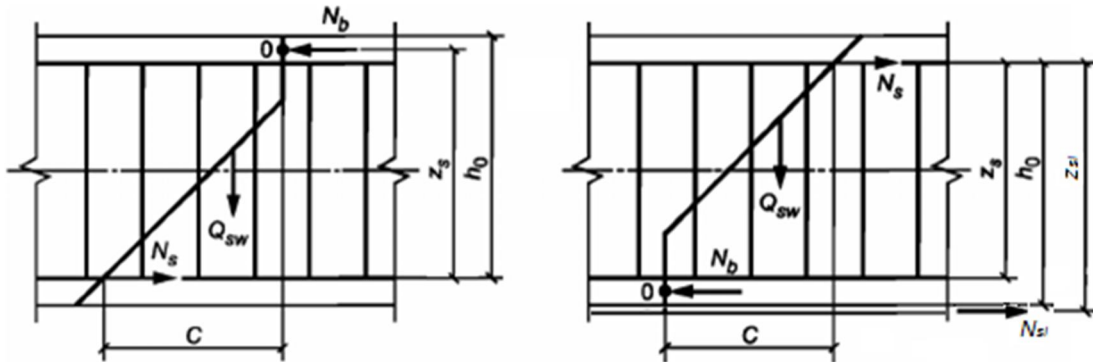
Схема усилий при расчете железобетонных элементов по наклонному сечению на действие моментов
